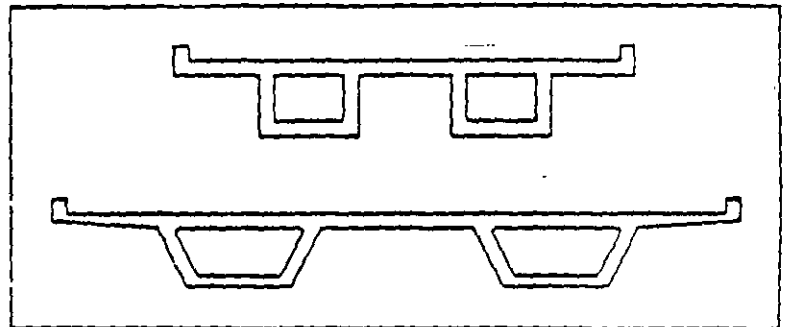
Sección transversal, tipo 31. Trabe Cajon, dos o más cajones
